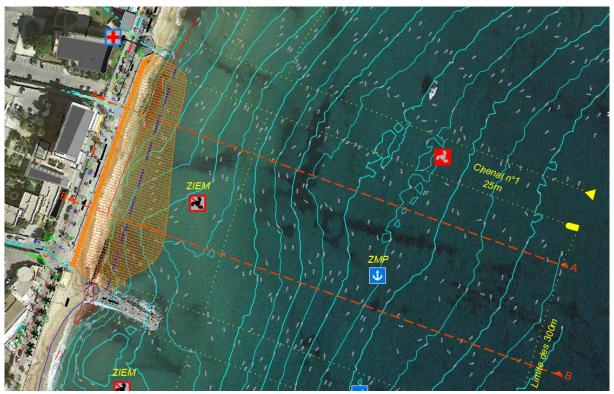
Vue en plan du rechargement de la plage du Centre-Ville
